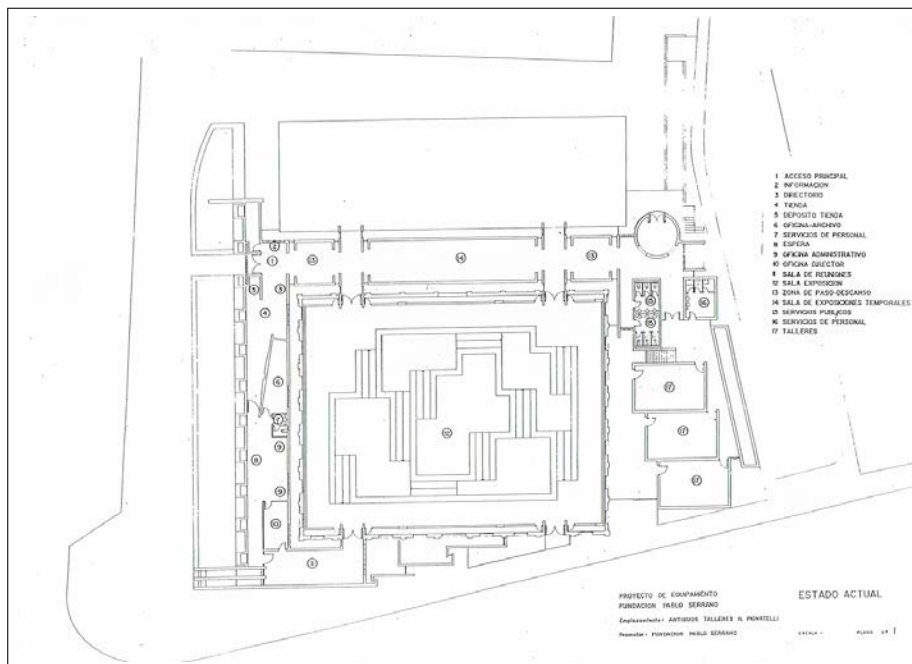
Planta del museo (según J.M. Pérez Latorre)
